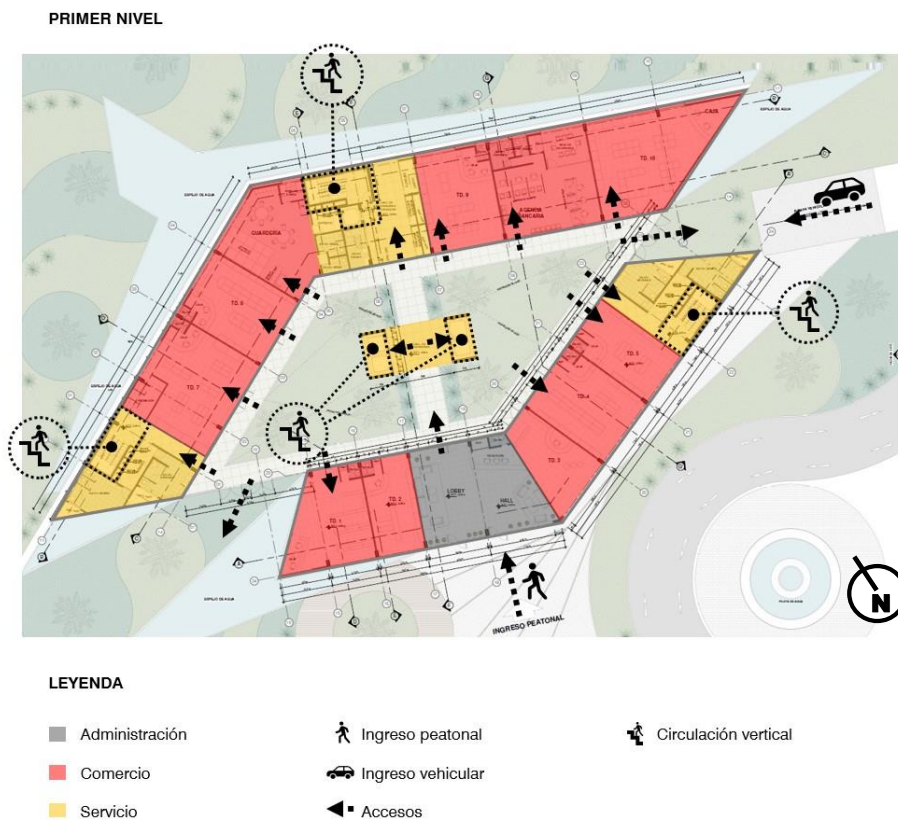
Plano de sectorización primer nivel. Elaboración propia
